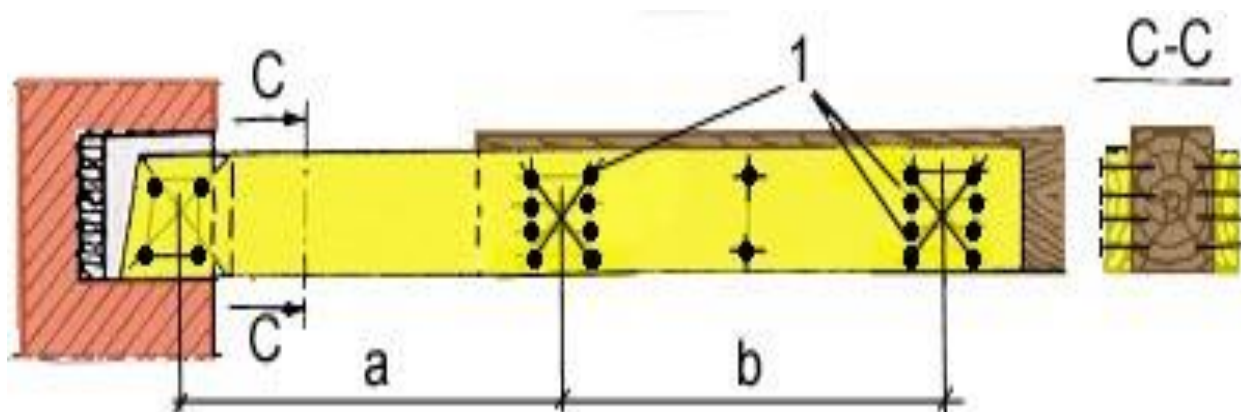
Усиление балки междуэтажного перекрытия деревянными накладками 1 – стальные крепежные элементы – нагельная группа (нагели, болты, гвозди – количество соединительных элементов определяется расчетом); 2 – боковые деревянные накладки (сечение определяется расчетом на изгиб).
